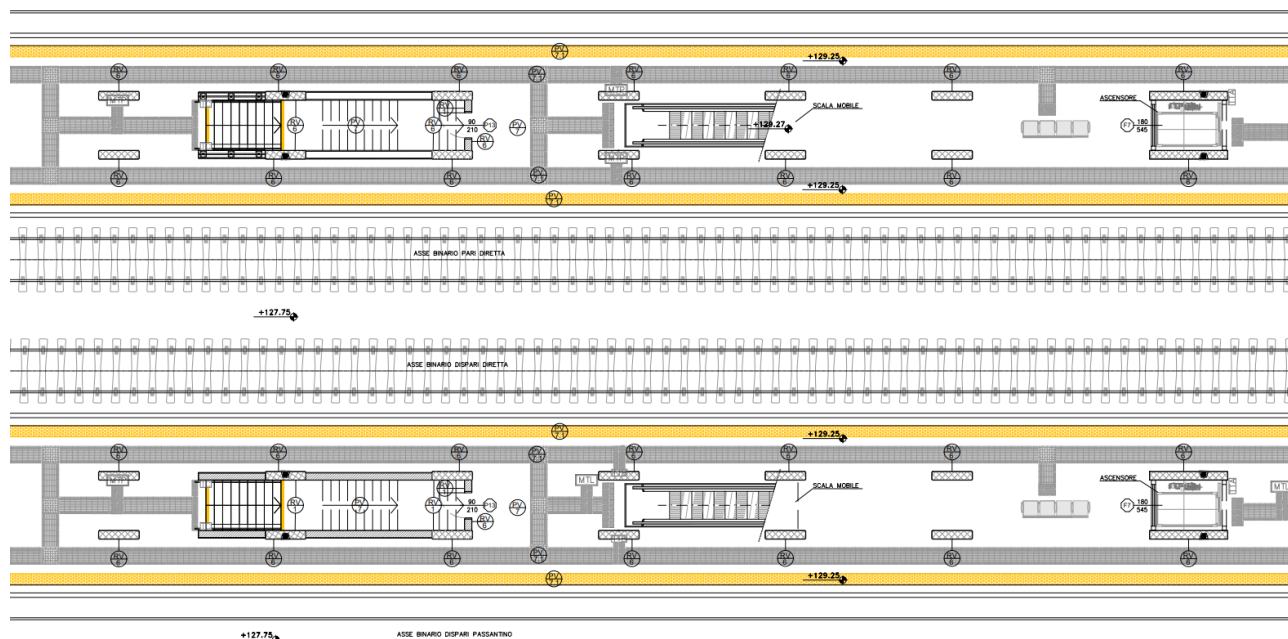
Dettaglio Pianta nuovo Piano Banchine esistente con indicazione delle finiture e dei materiali di progetto
